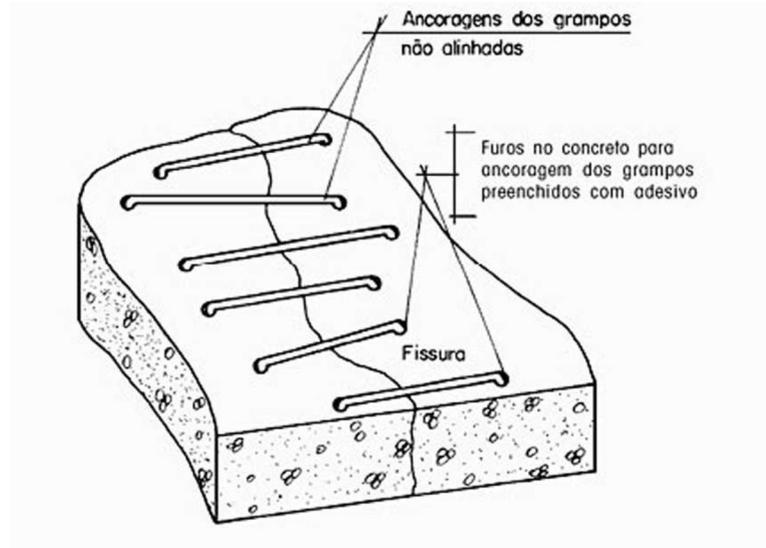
Reparo de fissuras por grampeamento (SOUZA, 1998)
